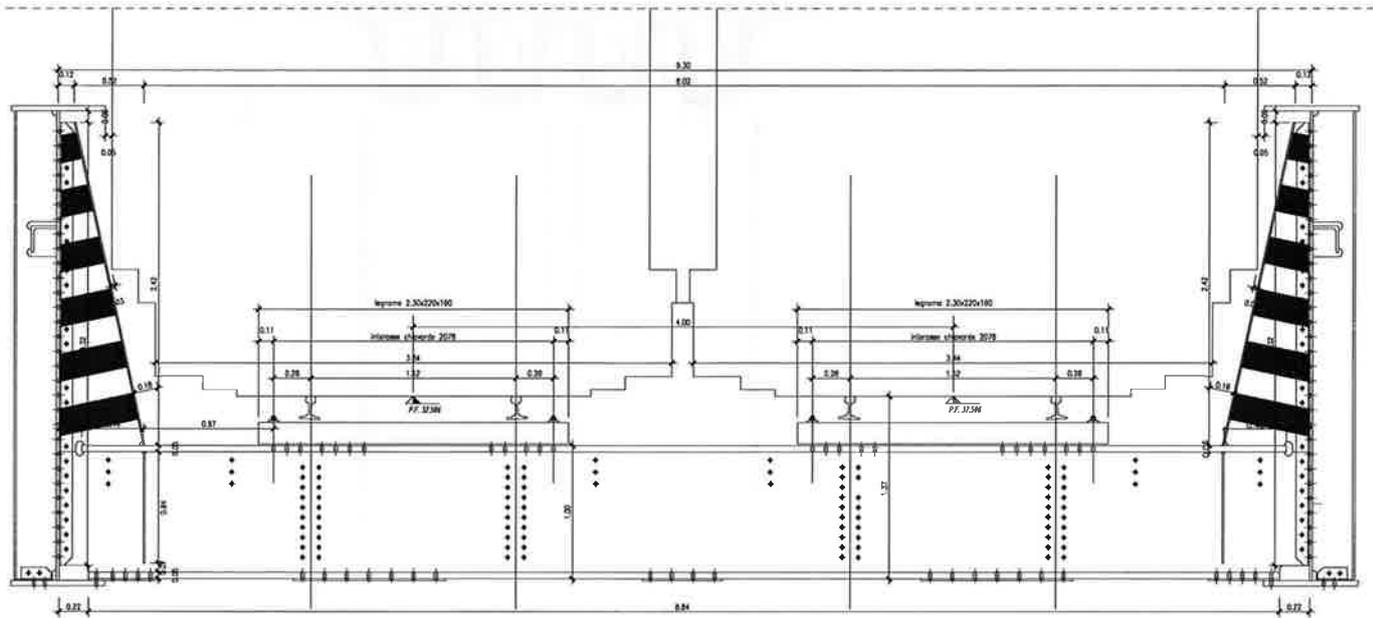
TIPO I4- trave in acciaio (parete piena) a via inferiore
